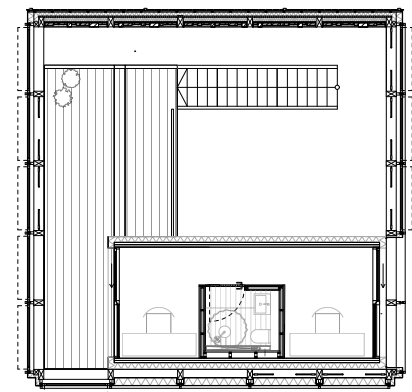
Grundriss 1. OG | M 1:200
